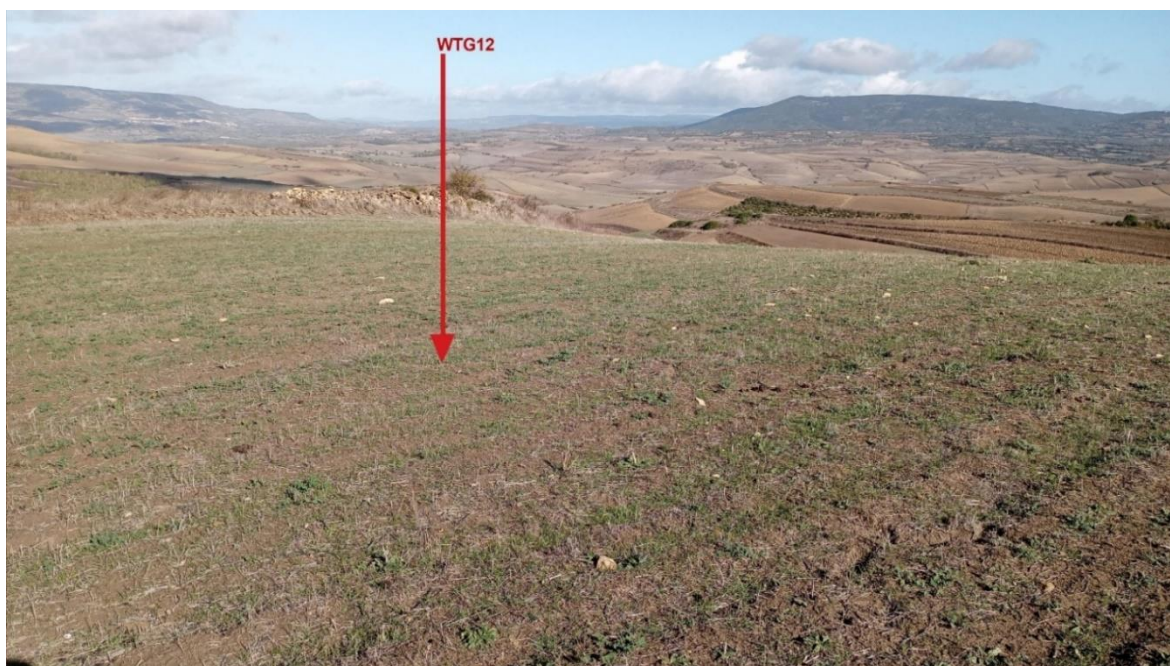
Area interessata dall'installazione della postazione WTG12
